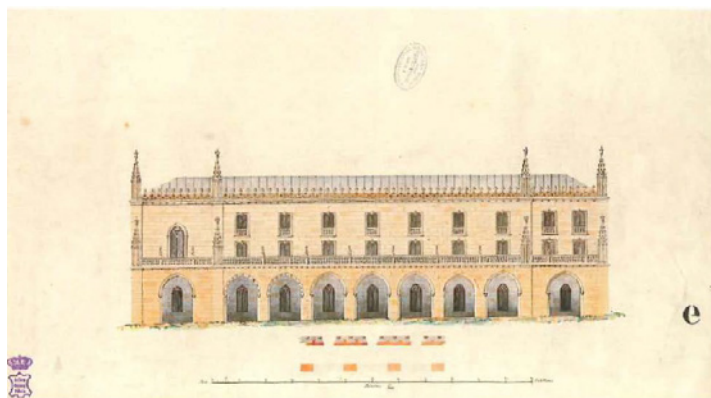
Proyecto de fachada sur del monasterio, Archivo General de Palacio.
